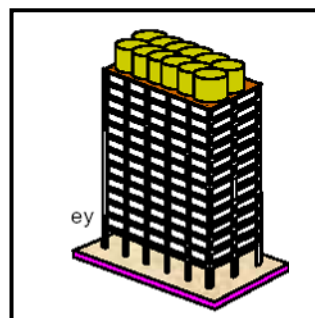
Bentuk bangunan dan denah yang tidak simetris
